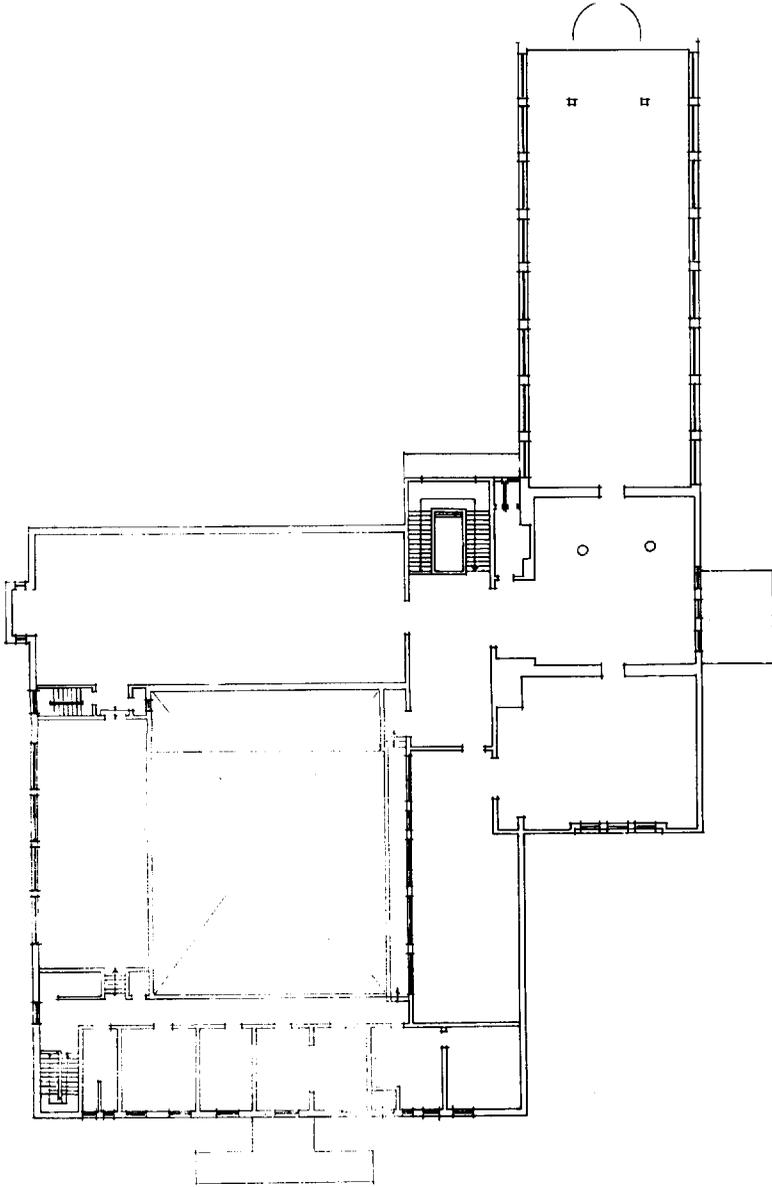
مسقط أفقى للدور الأرضى لمتحف بورسعيد القومى .
